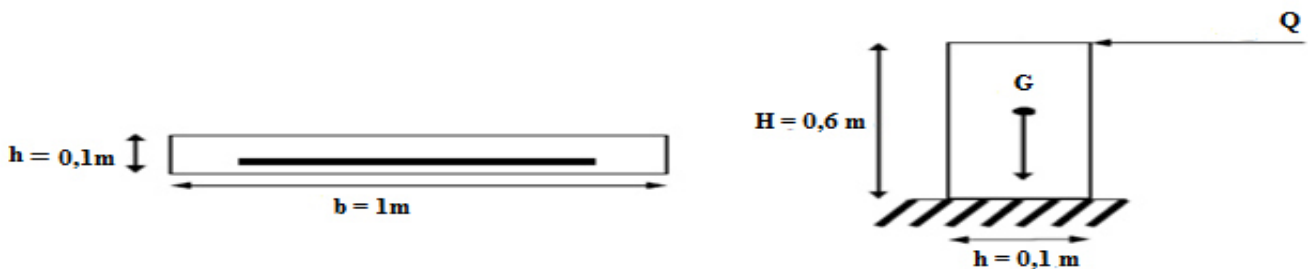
Coupe transversale et longitudinale de l'acrotère.
